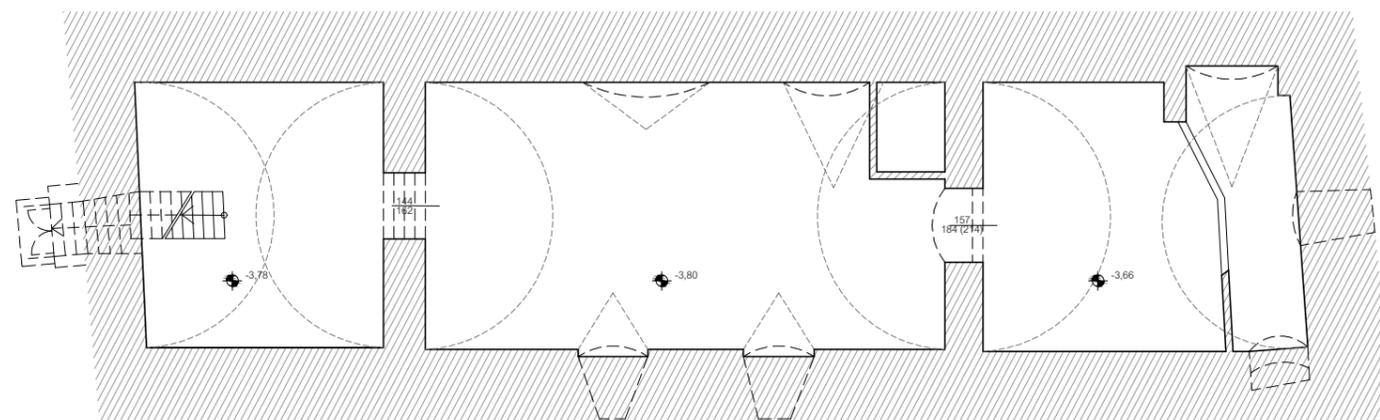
Bestandsplan, Kellergeschoß, M 1:150
